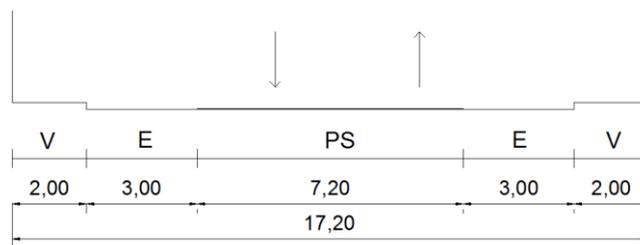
Sección vial calle Adolfo de la Jara B. colinda con el terreno.
